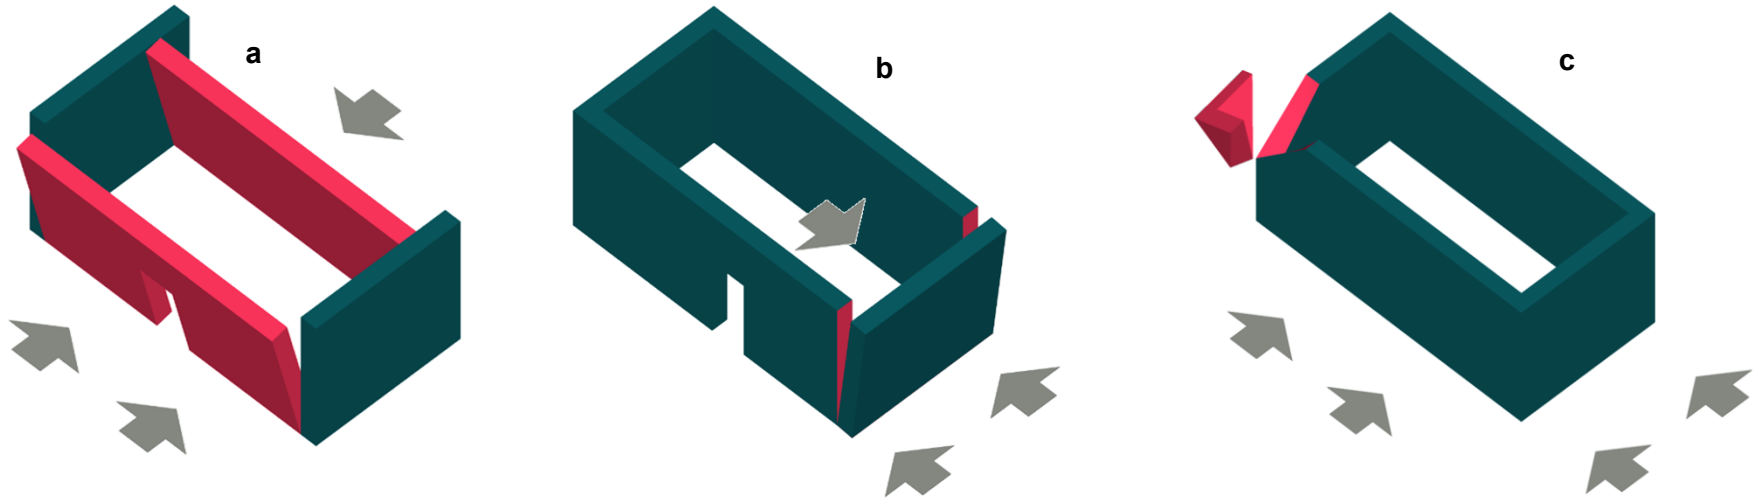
a) Colapso por falta de anclaje entre las paredes y los diafragmas horizontales. b) Colapso de muros cortos fuera del plano c) Colapso fuera del plano en esquina Fuente: Elaboración propia en base a Paulo Lorenço.
